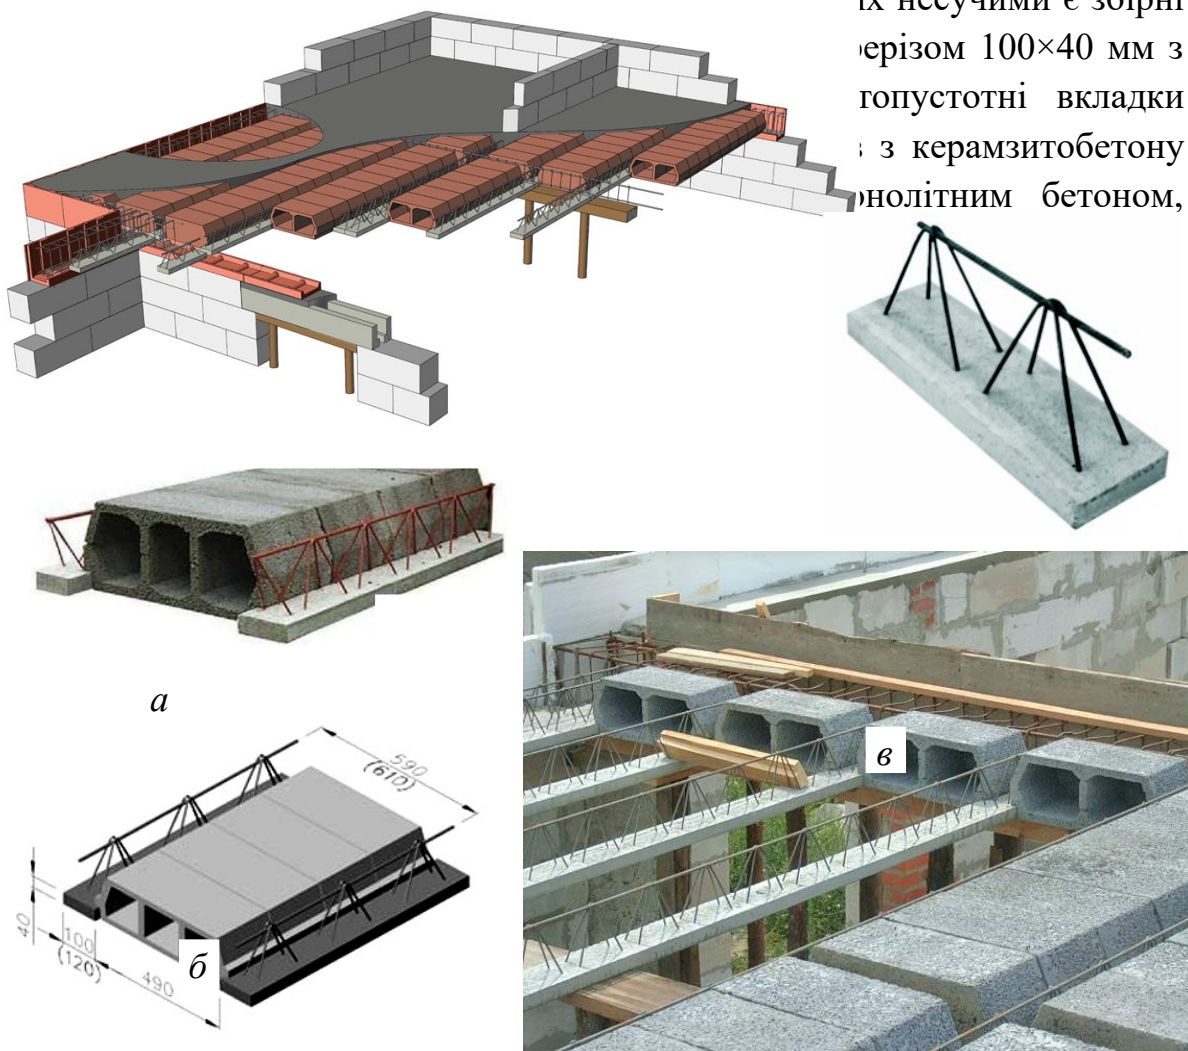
Збірно-монолітні перекриття по залізобетонних балках:
